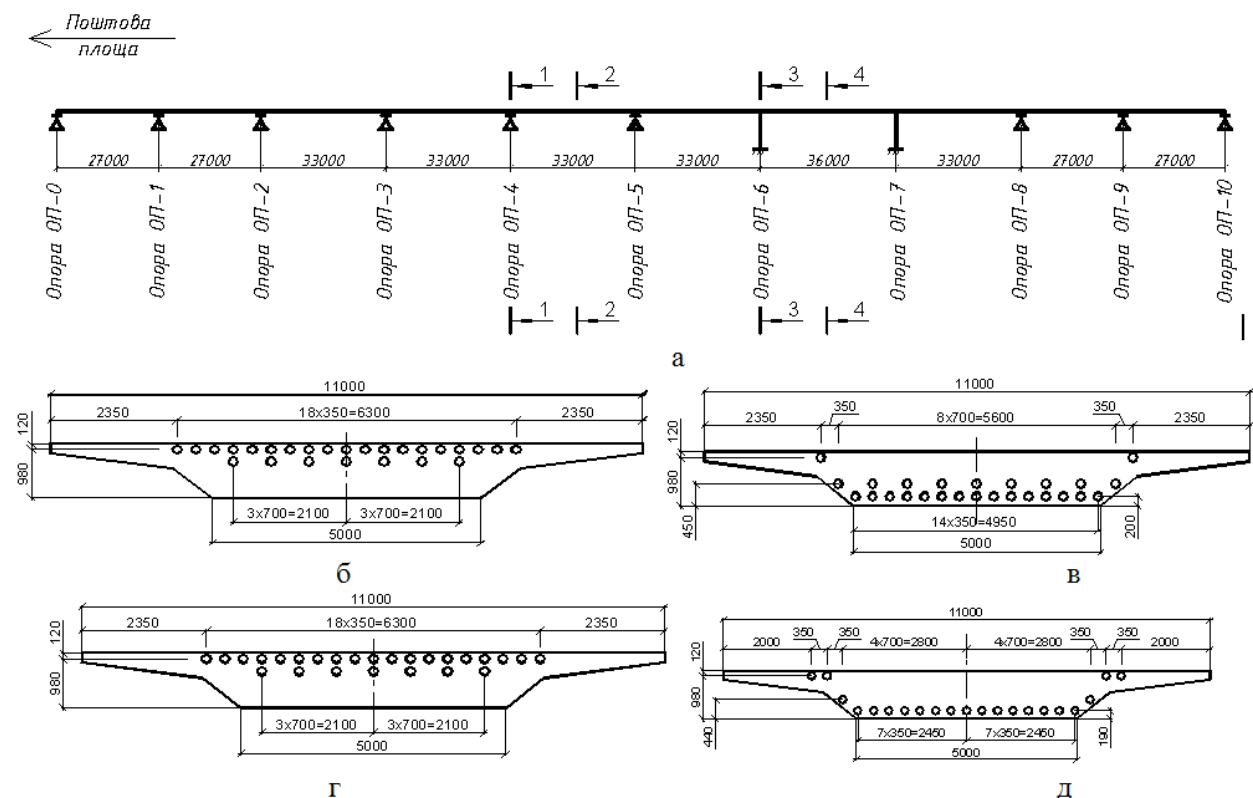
а – схема естакади; б – переріз 1-1; в – переріз 2-2; г – переріз 3-3; д – переріз 4-4
